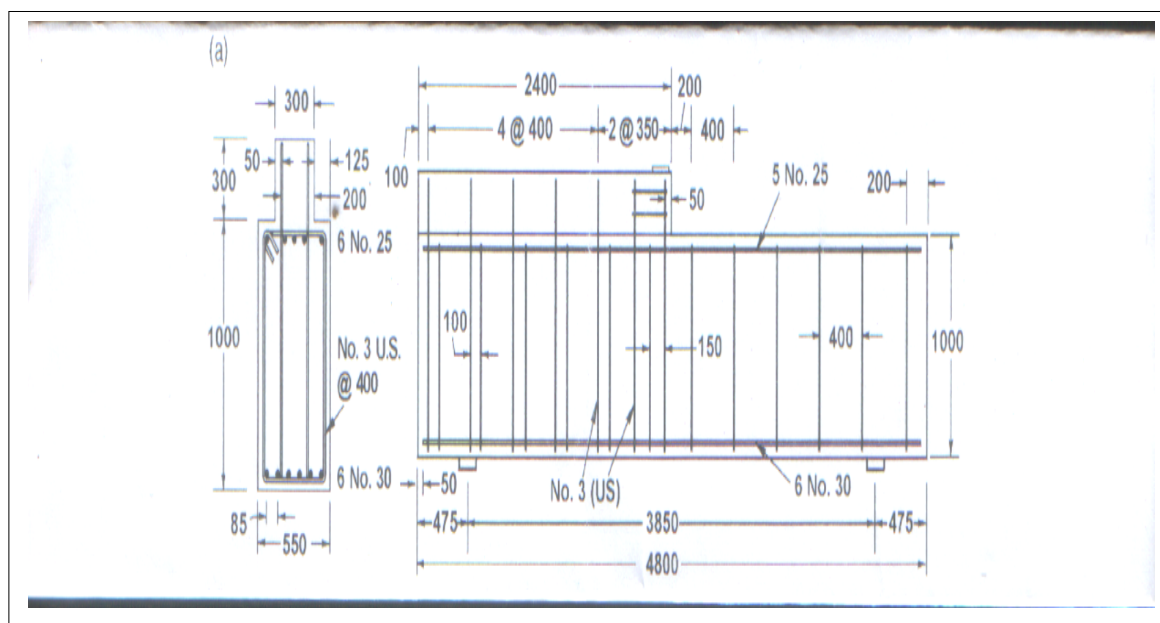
Schéma de ferrailage des poutres d'essais [56]
